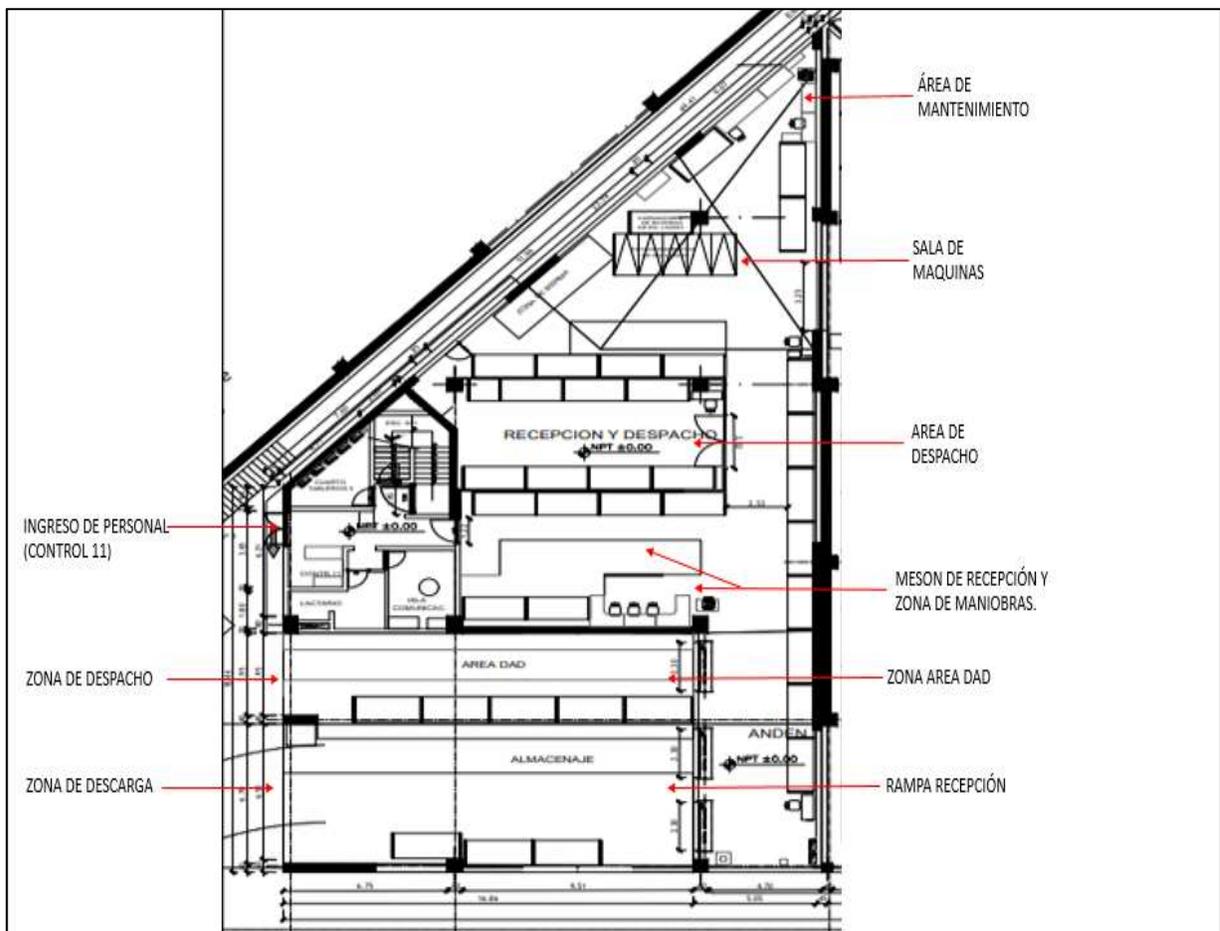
Layout del Almacén, empresa de Retail, Chimbote
